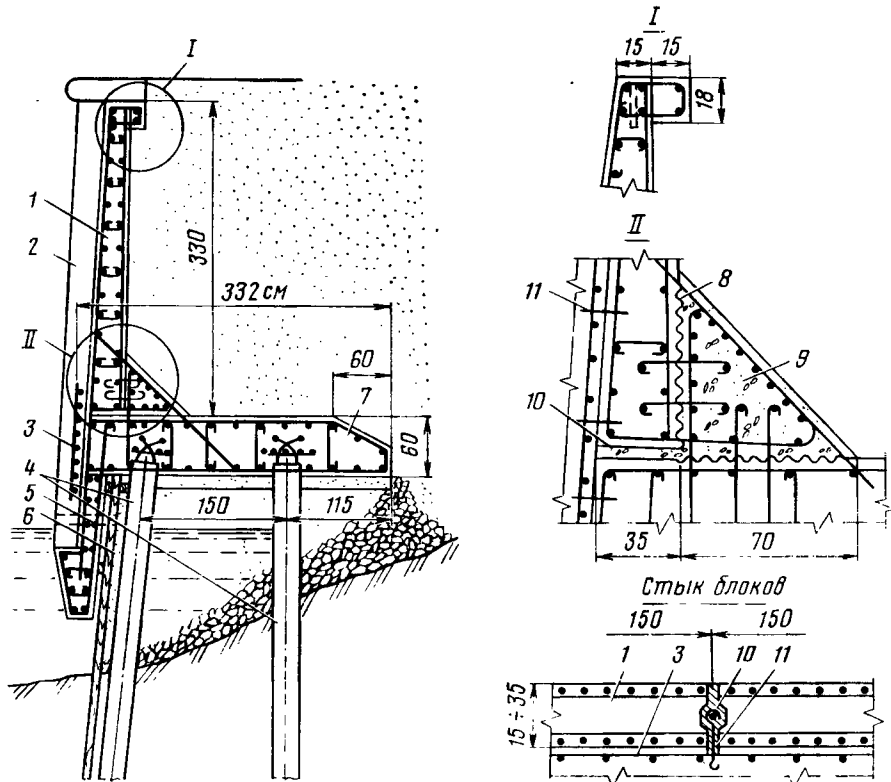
Конструкция подпорной стены на высоком свайном ростверке:
